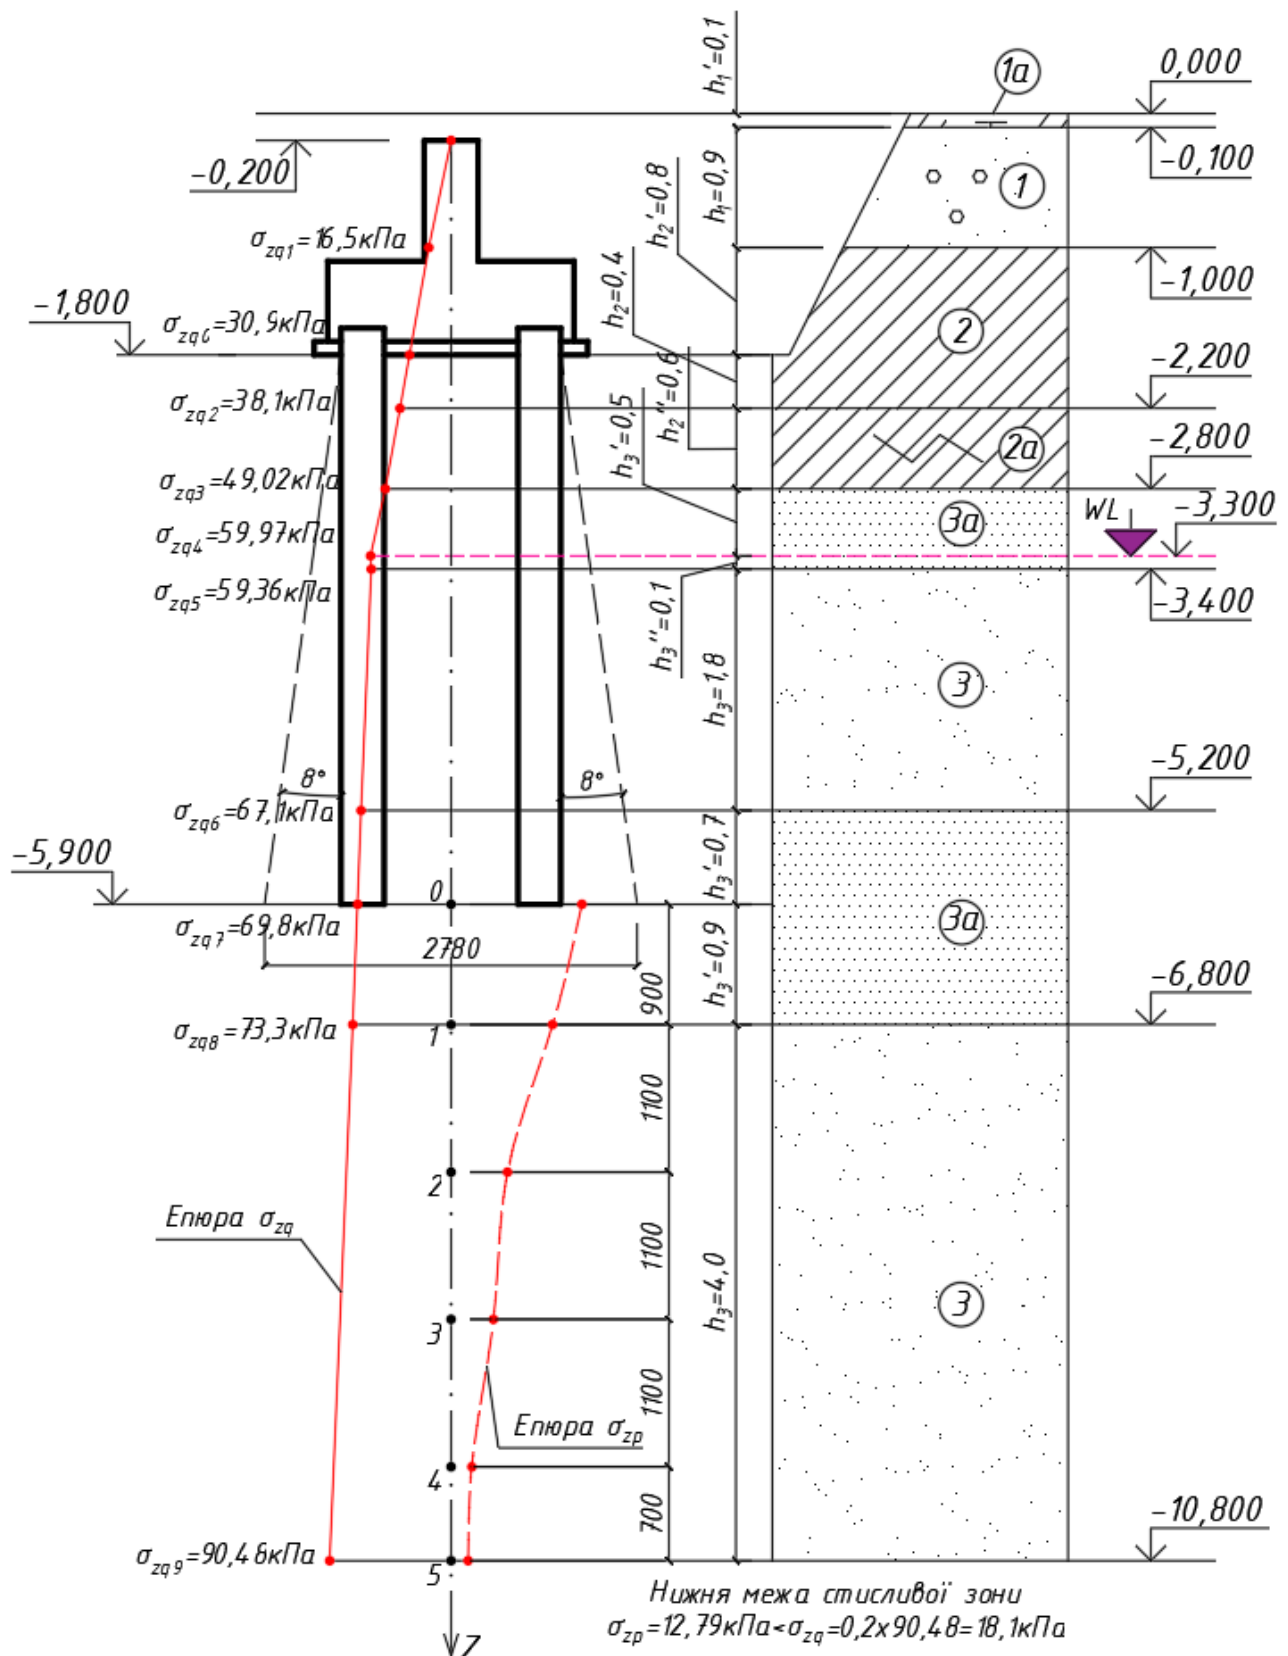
Схема до розрахунку осідання стрічкового фундаменту під колонами.
